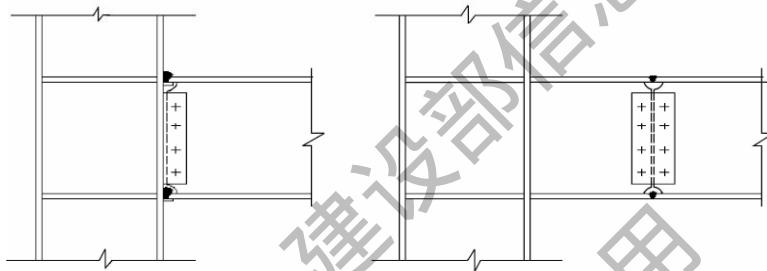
型钢混凝土柱与钢梁或型钢混凝土梁内型钢的连接构造
